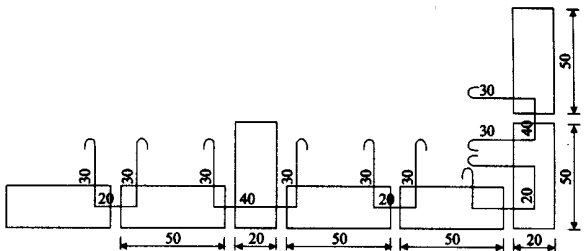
细石砼浆砌料石镜面平面图(单位:cm)
